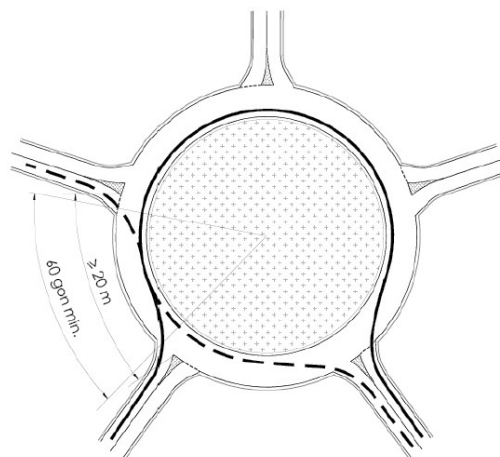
Medidas en planta entre los accesos en una glorieta. Fuente: Norma 3.1.I.C Trazado, de la instrucción de carreteras.
